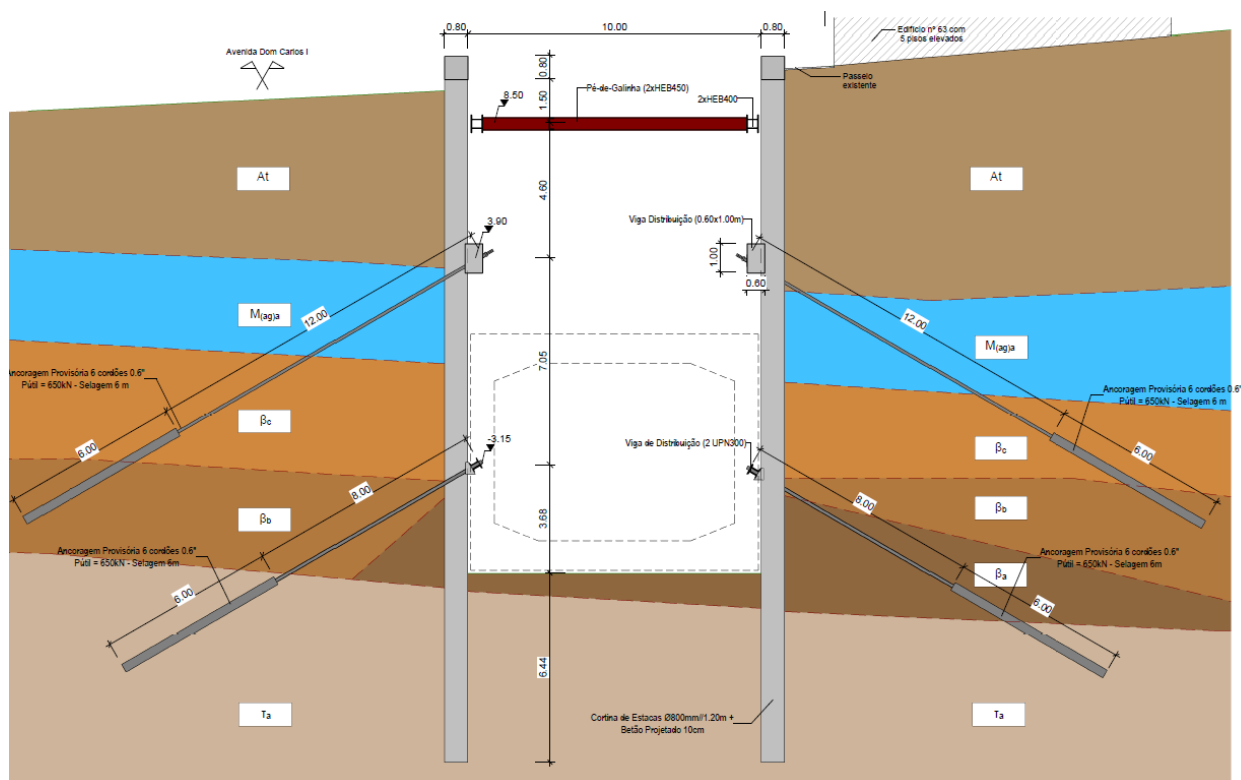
Solução de Escavação e Contenção Periférica – Secção tipo do PK 1+490
